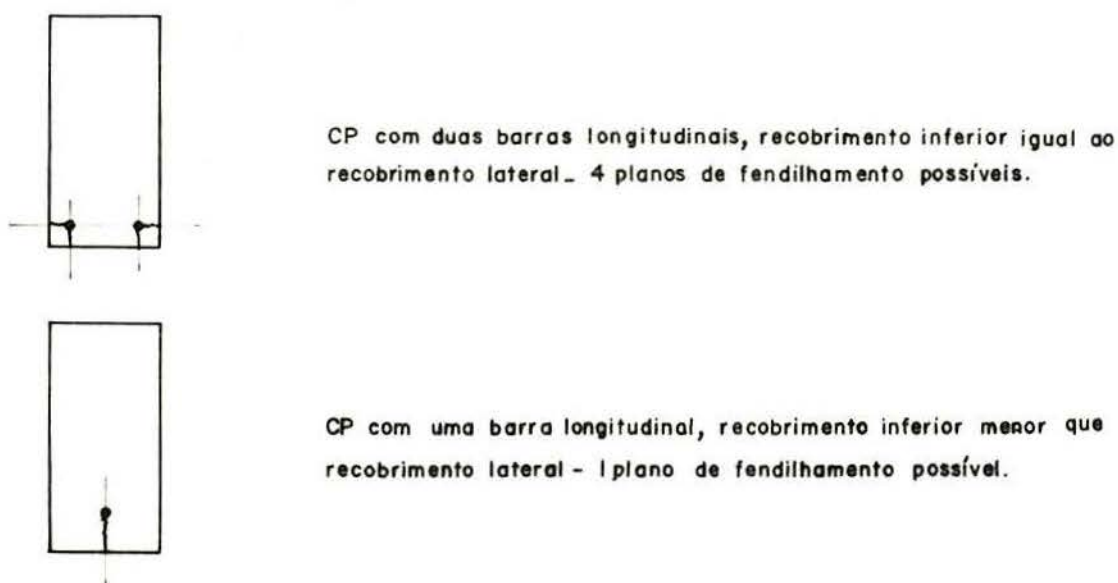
Possíveis planos de fendilhamento para os CP com uma ou com duas barras longitudinais.
